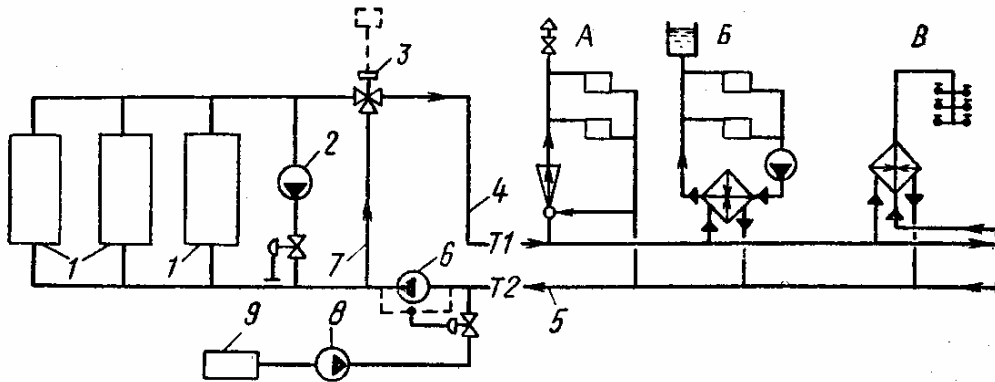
Принципиальная схема теплоснабжения от районной котельной с водогрейными котлами
